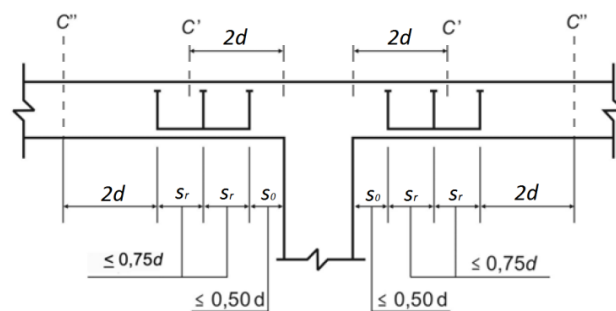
Disposição da armadura de punção em corte [modificado – NBR 6118:2014 Figura 19.9]
